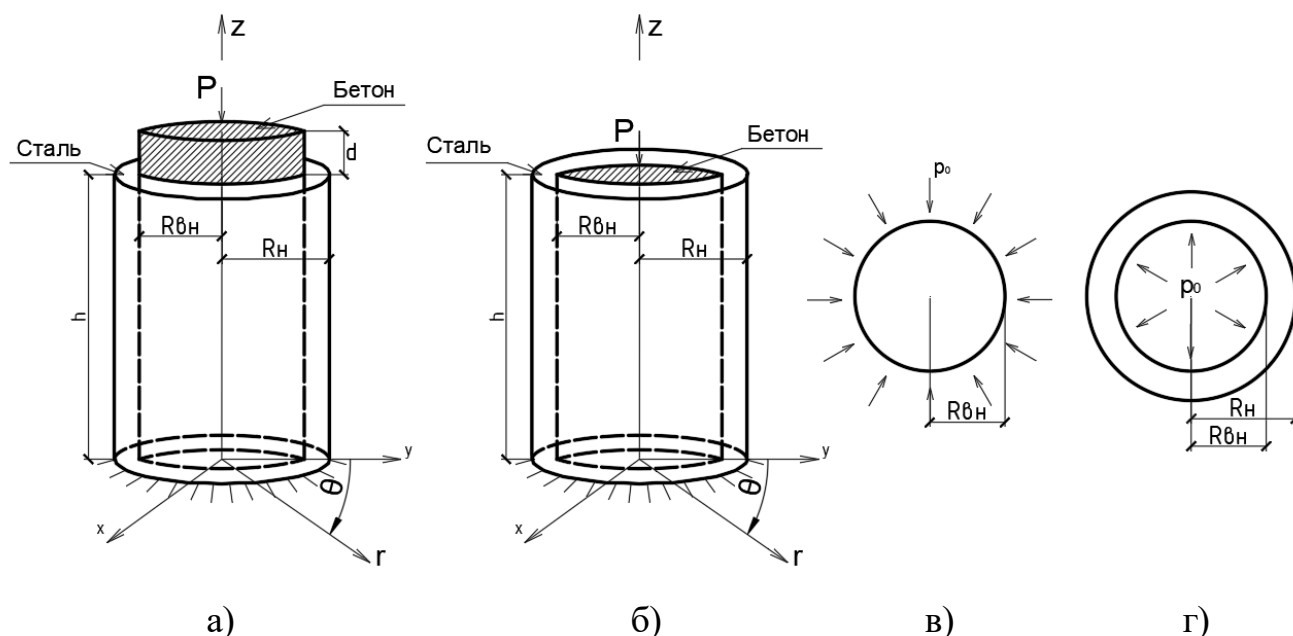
Расчетная схема предварительно напряженной трубобетонной стойки: а) стойка на стадии 1 работы; б) стойка на стадии 2 работы; в) схема обжатия сечения бетонного ядра; г) схема воздействия бетонного ядра на сечение стальной трубы.
